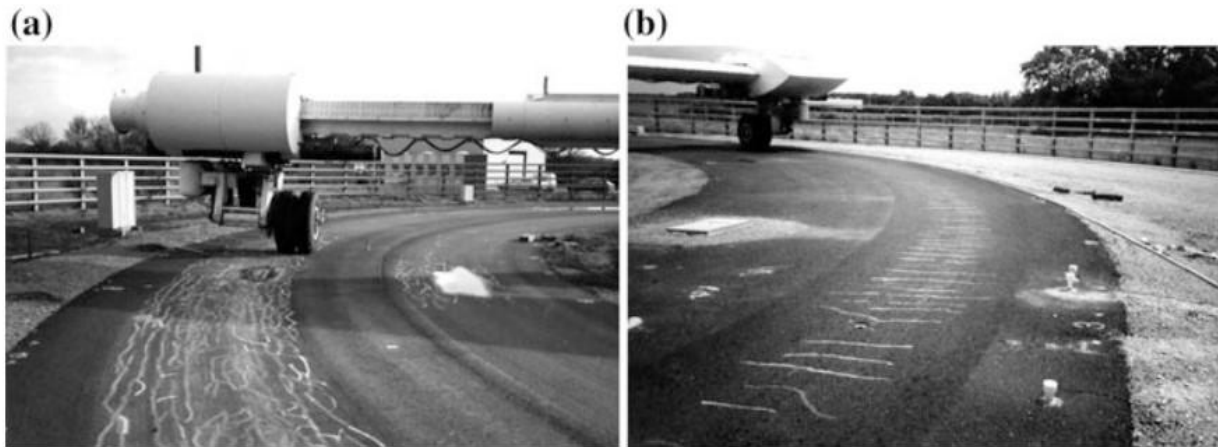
(a) Fissures typiques observées au manège pour les chaussées minces et (b) les chaussées épaisses [Hornych et al., 2008]
